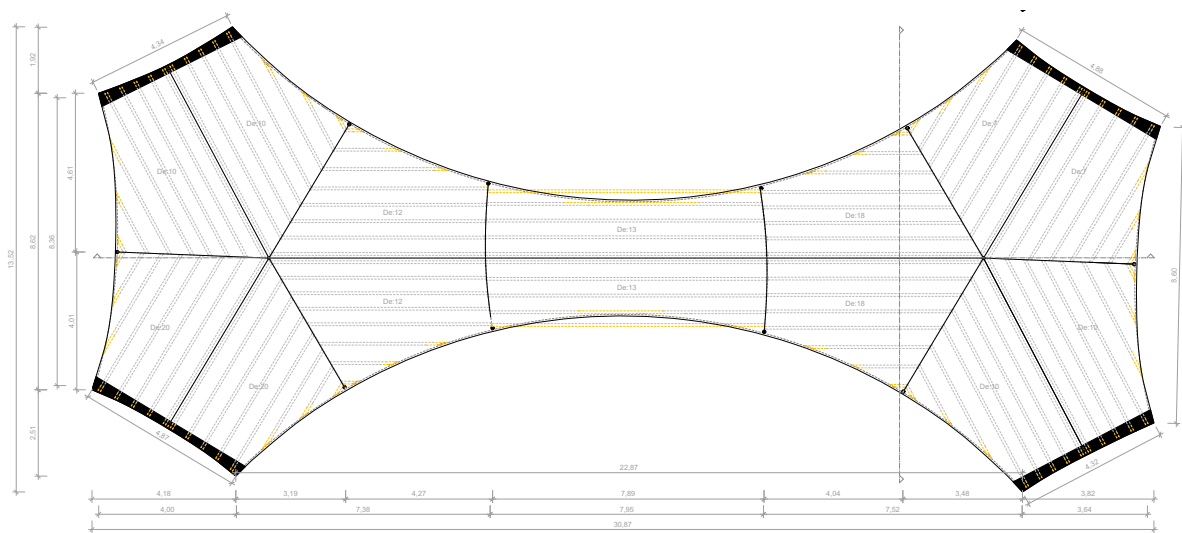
Grundriss des finalen Entwurfs der Fahrradüberdachung Friedrich-Schiller-Gymnasium Marbach
